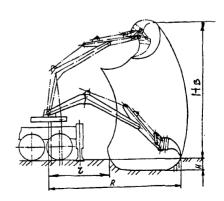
Рабочие размеры экскаватора ЭО-4421A с оборудованием зуба-рыхлителя
